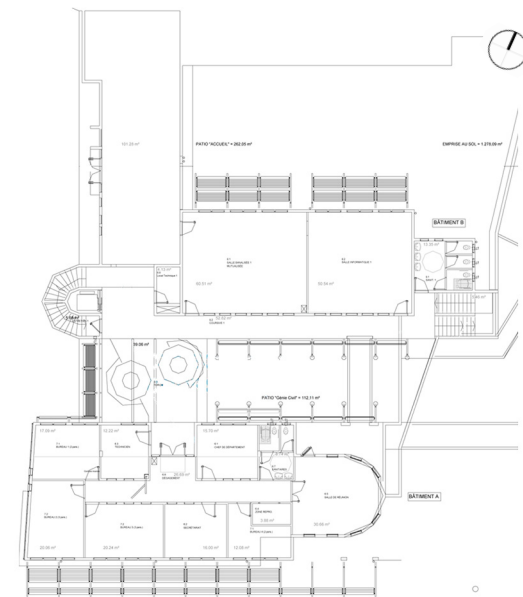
Pianta piano terra; Fonte: Imageen, 2011;
